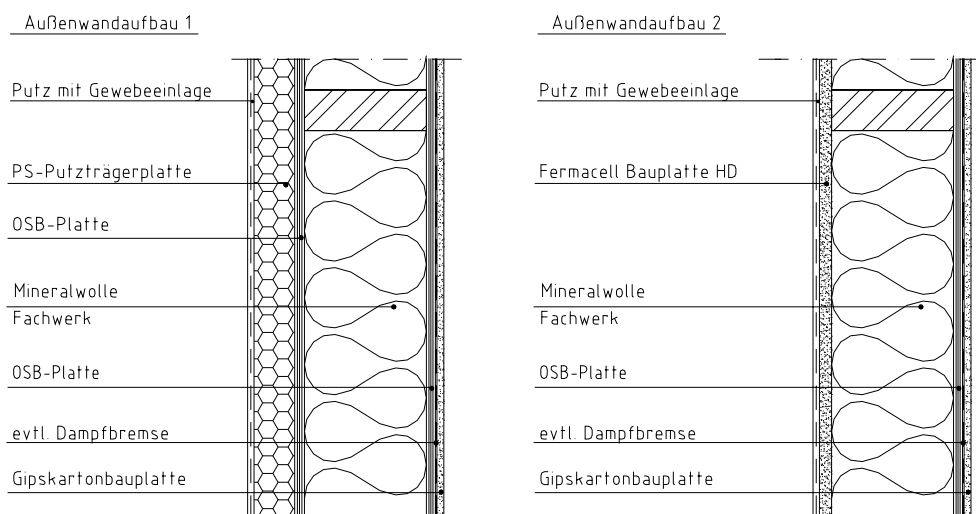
Außenwandaufbau der Erdgeschosswände
